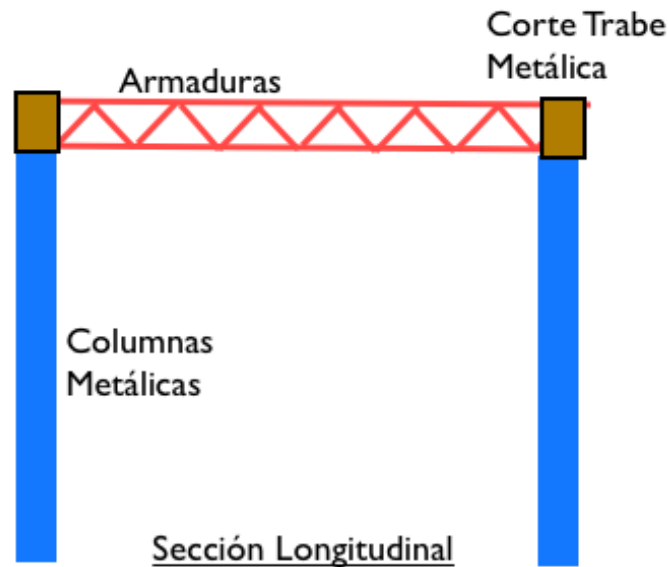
Tipo de estructura. Fuente: <http://aceroarenas.blogspot.com>. (2012).
